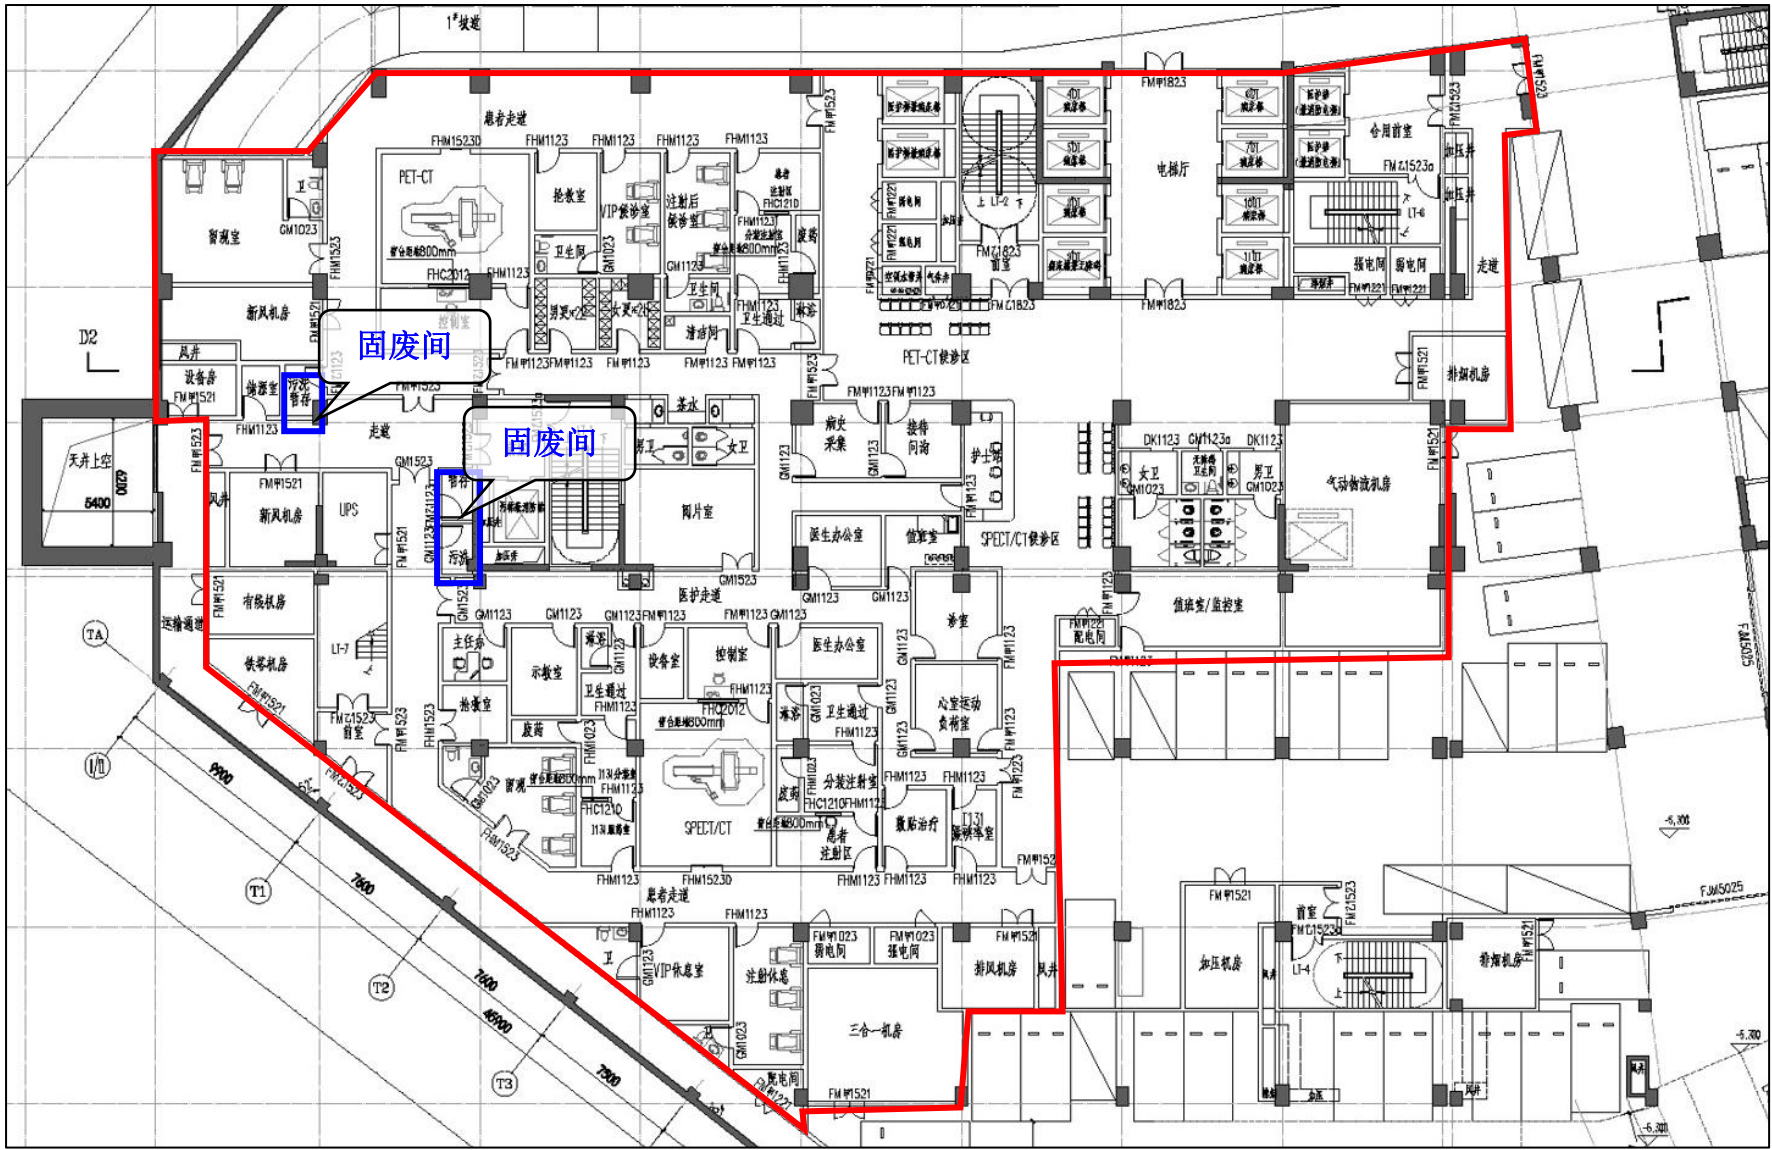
(21) 核医学科 (地下一层) 平面布置
